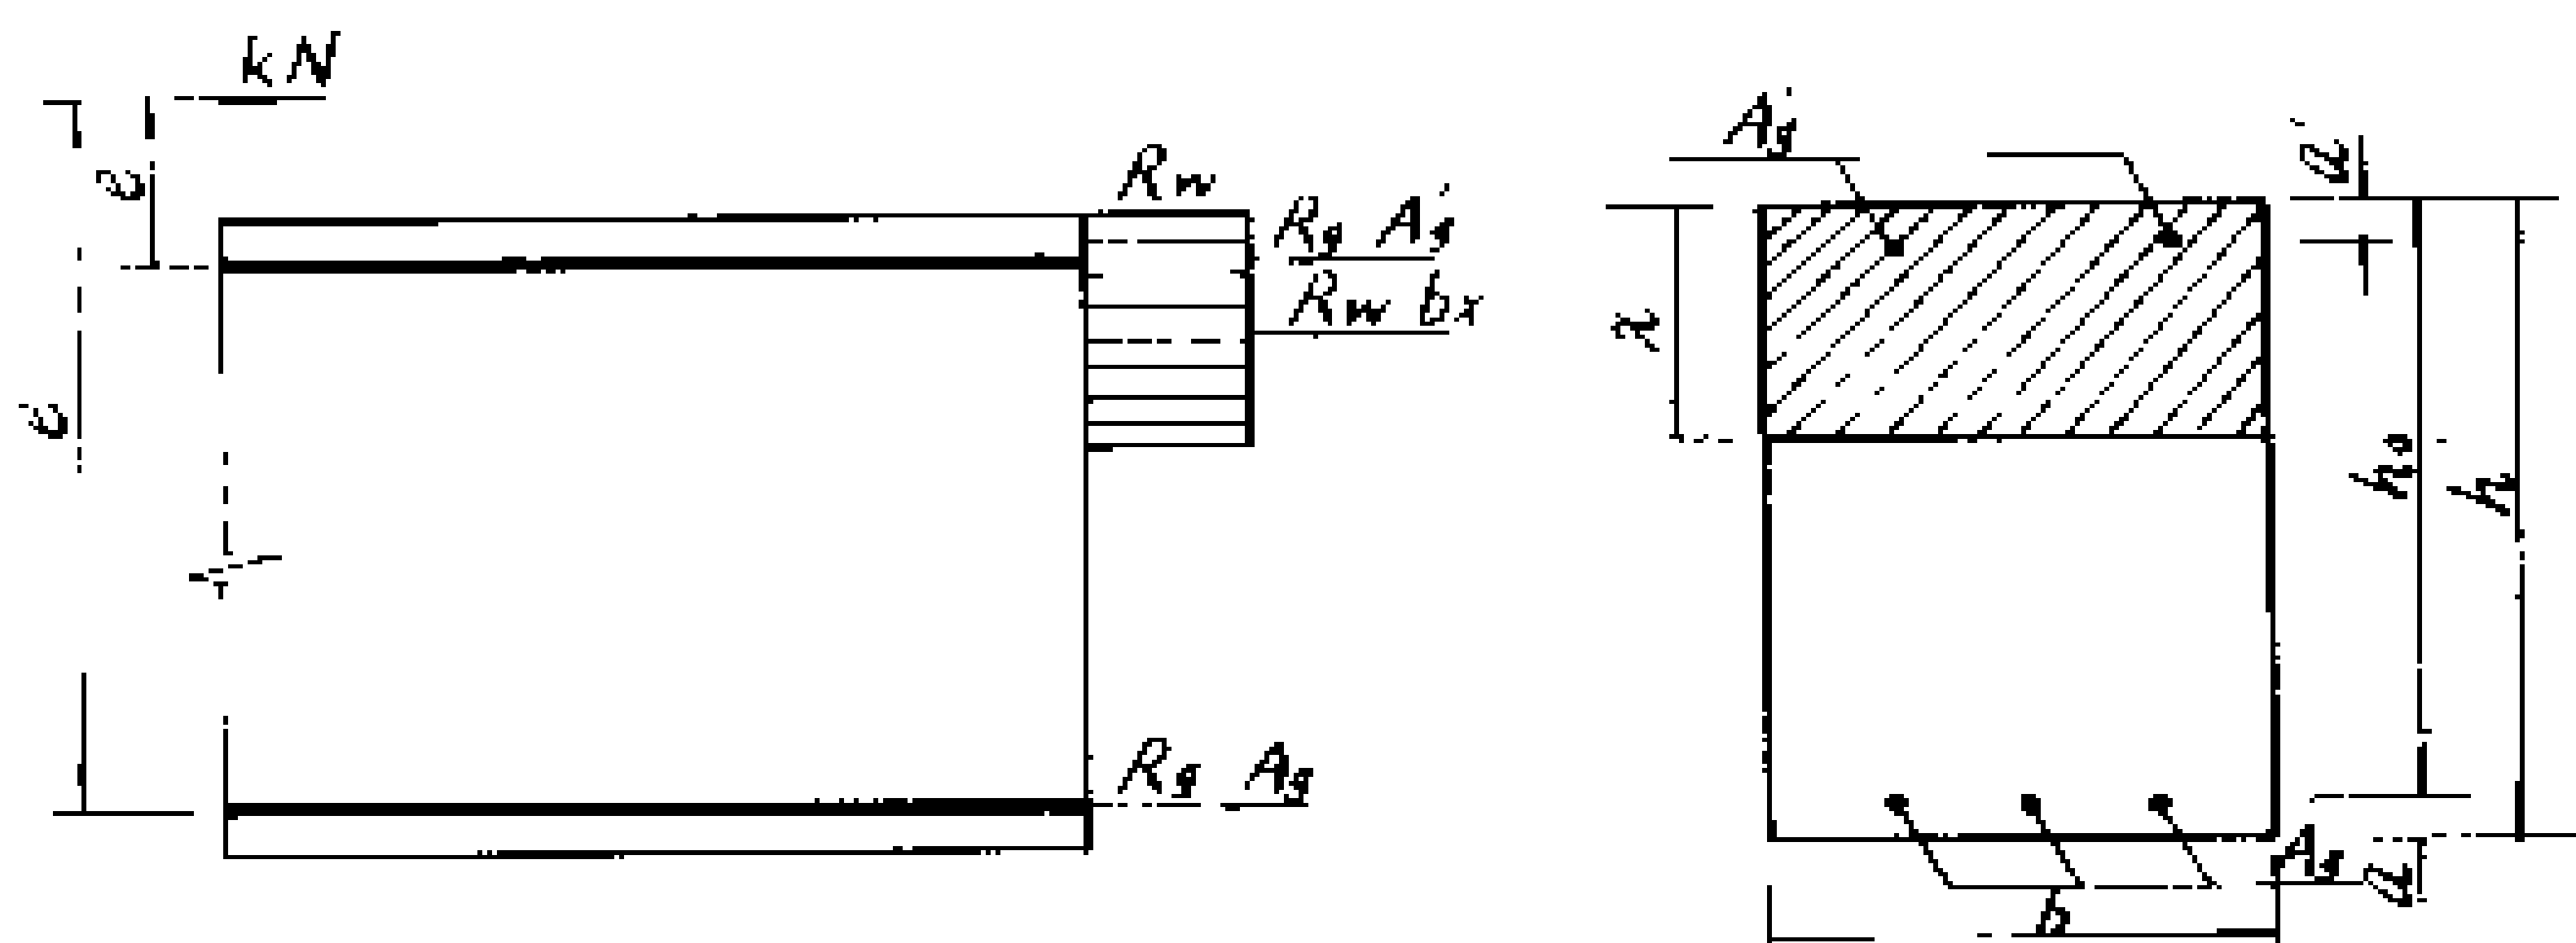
钢筋混凝土大偏心受压构件截面强度计算图
